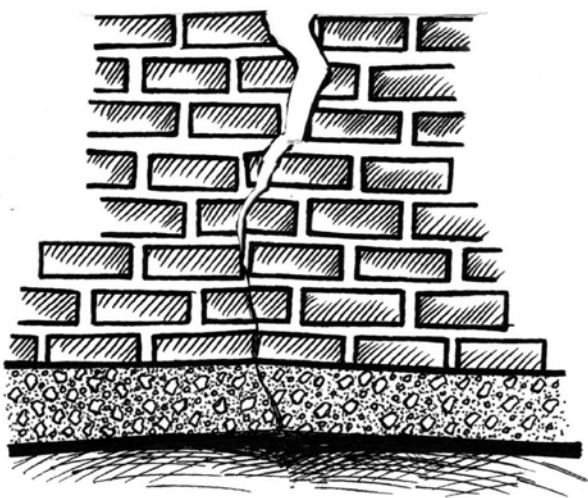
При неровном фундаменте здание тела будет со временем неминуемо давать трещины
